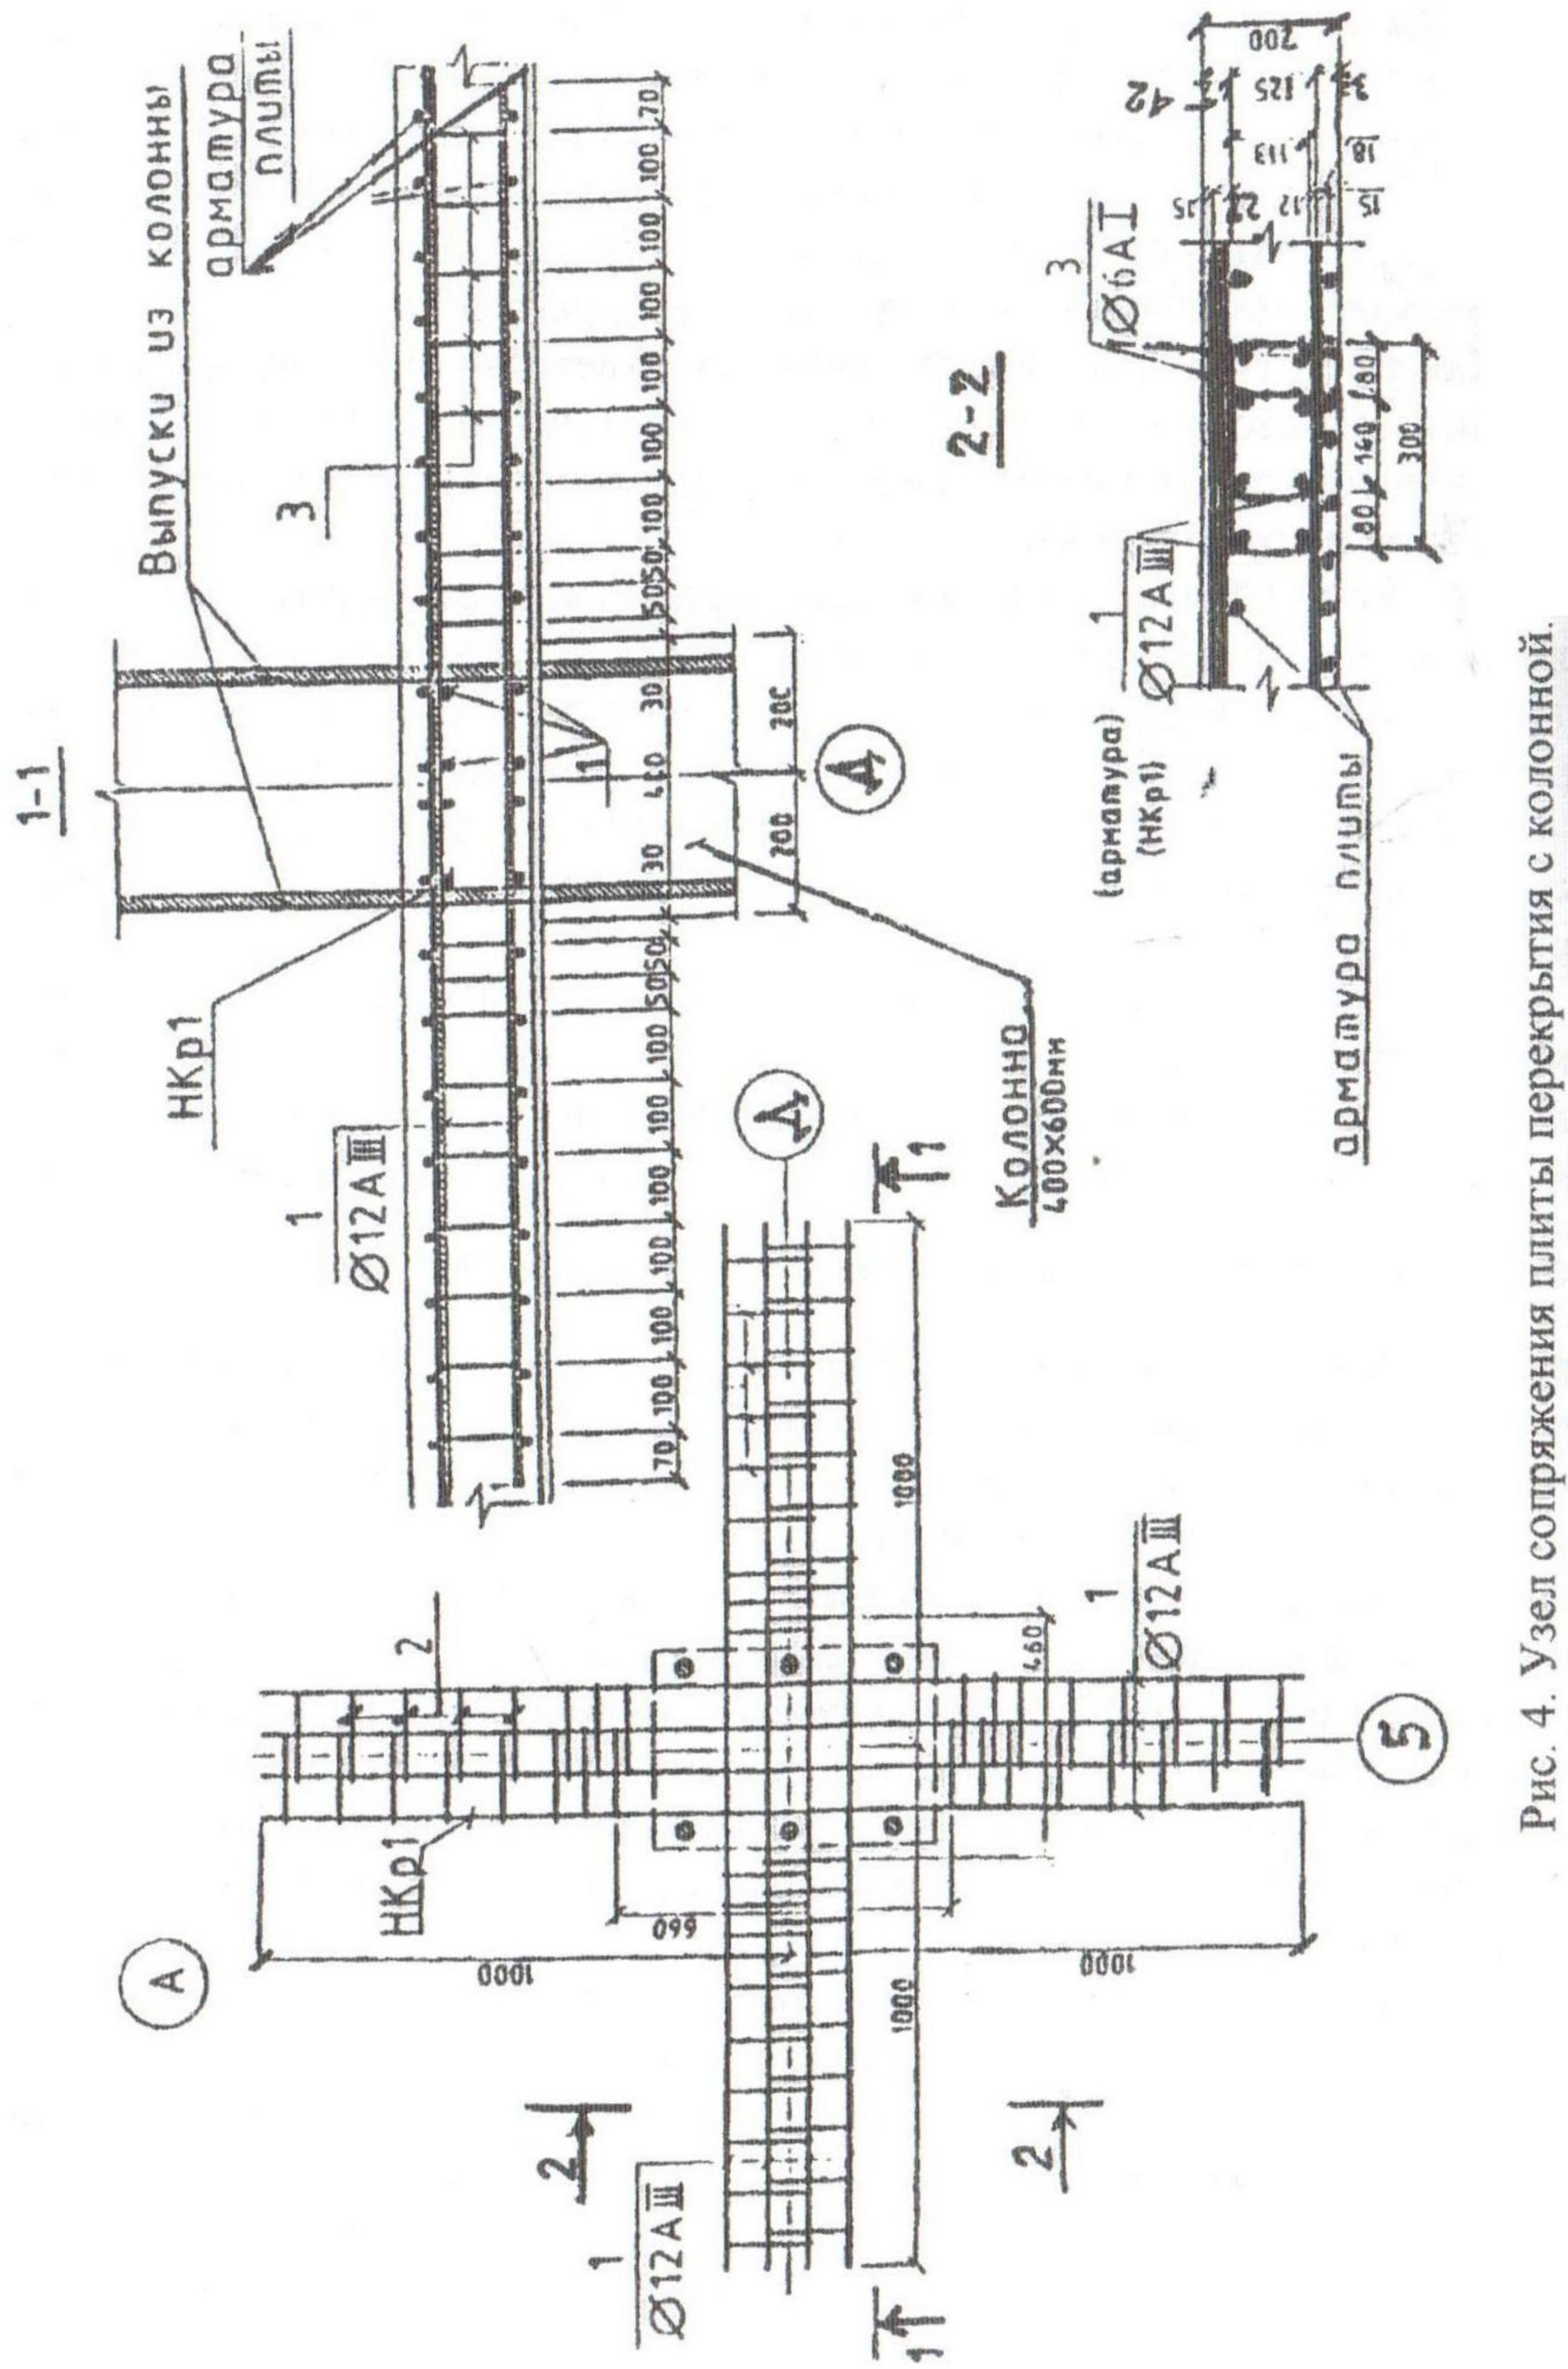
Узел сопряжения плиты перекрытия с колоннной.
